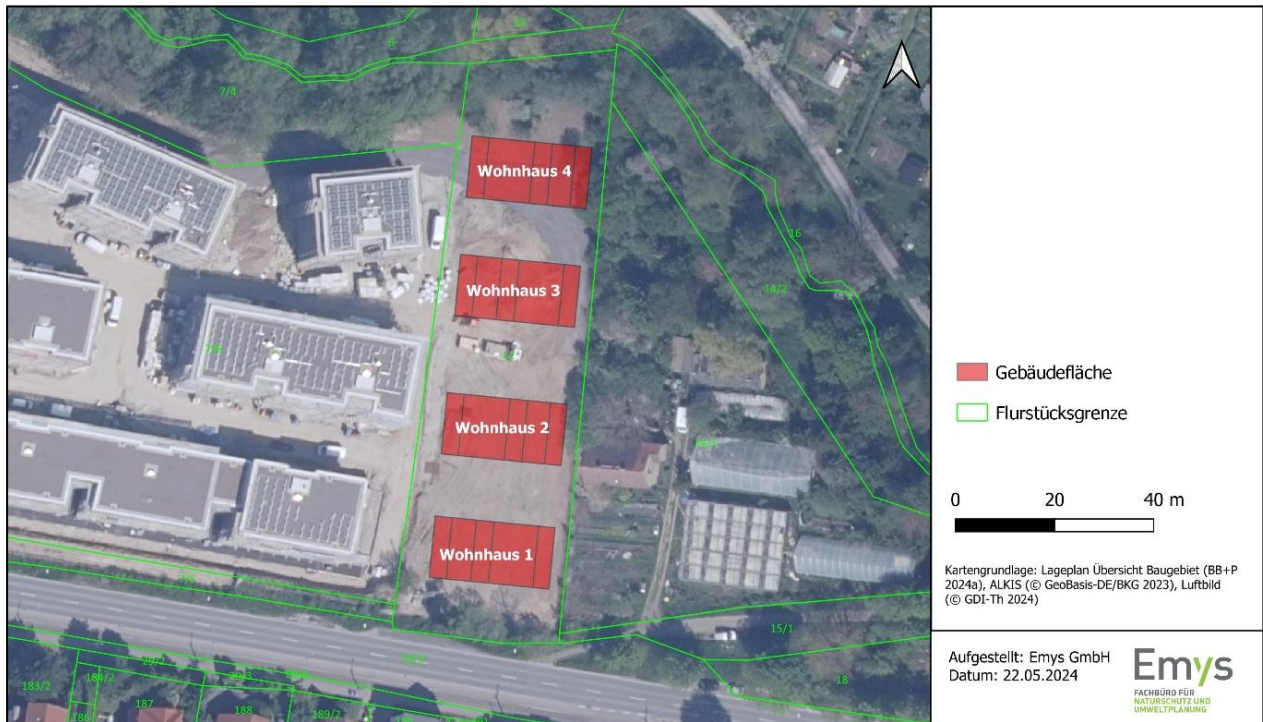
Lageplan der geplanten Wohngebäude (Eigene Darstellung).
